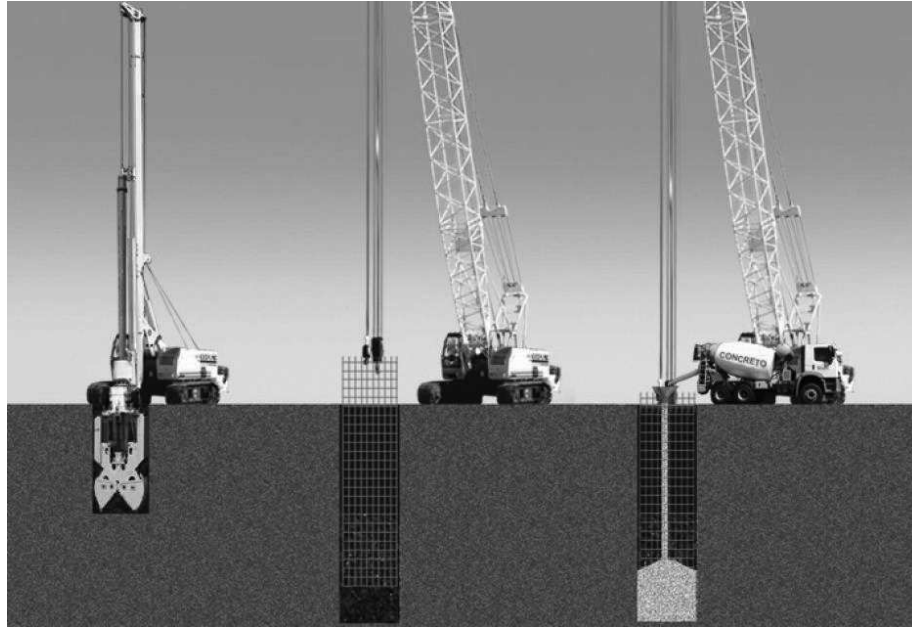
Fases de escavação, colocação da armadura e concretagem da parede-diafragma
